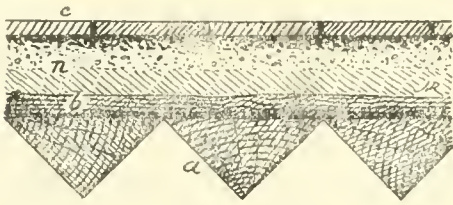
Coupe en travers d'un plancher à solives triangulaires.
